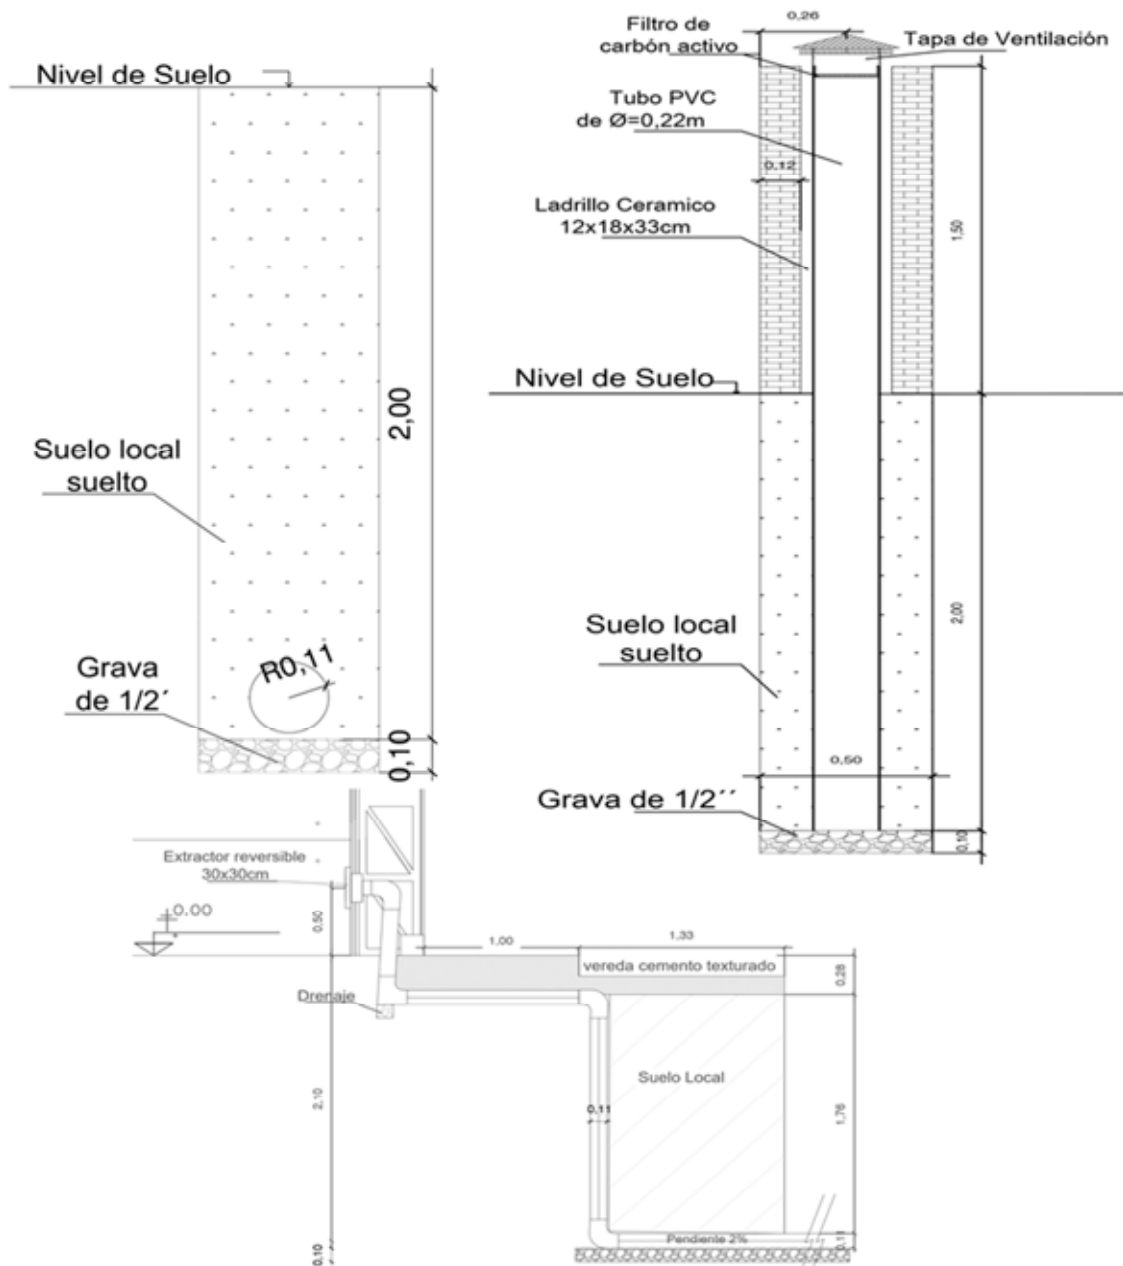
Detalles de la instalación de geotermia de baja entalpía..
